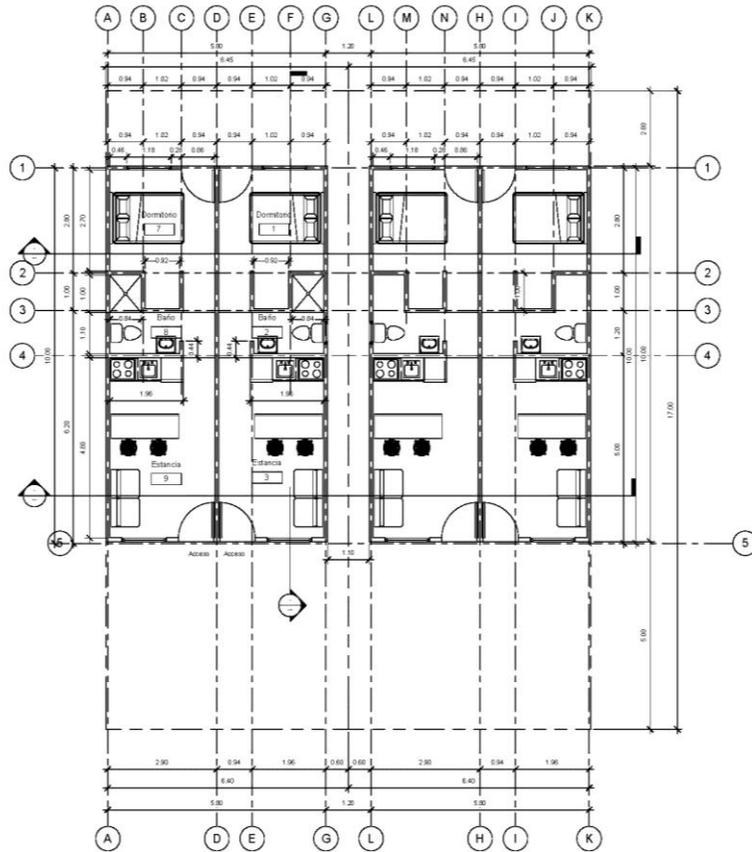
Planta arquitectónica de dos dúplex en terreno de 51m<sup>2</sup> cada uno
